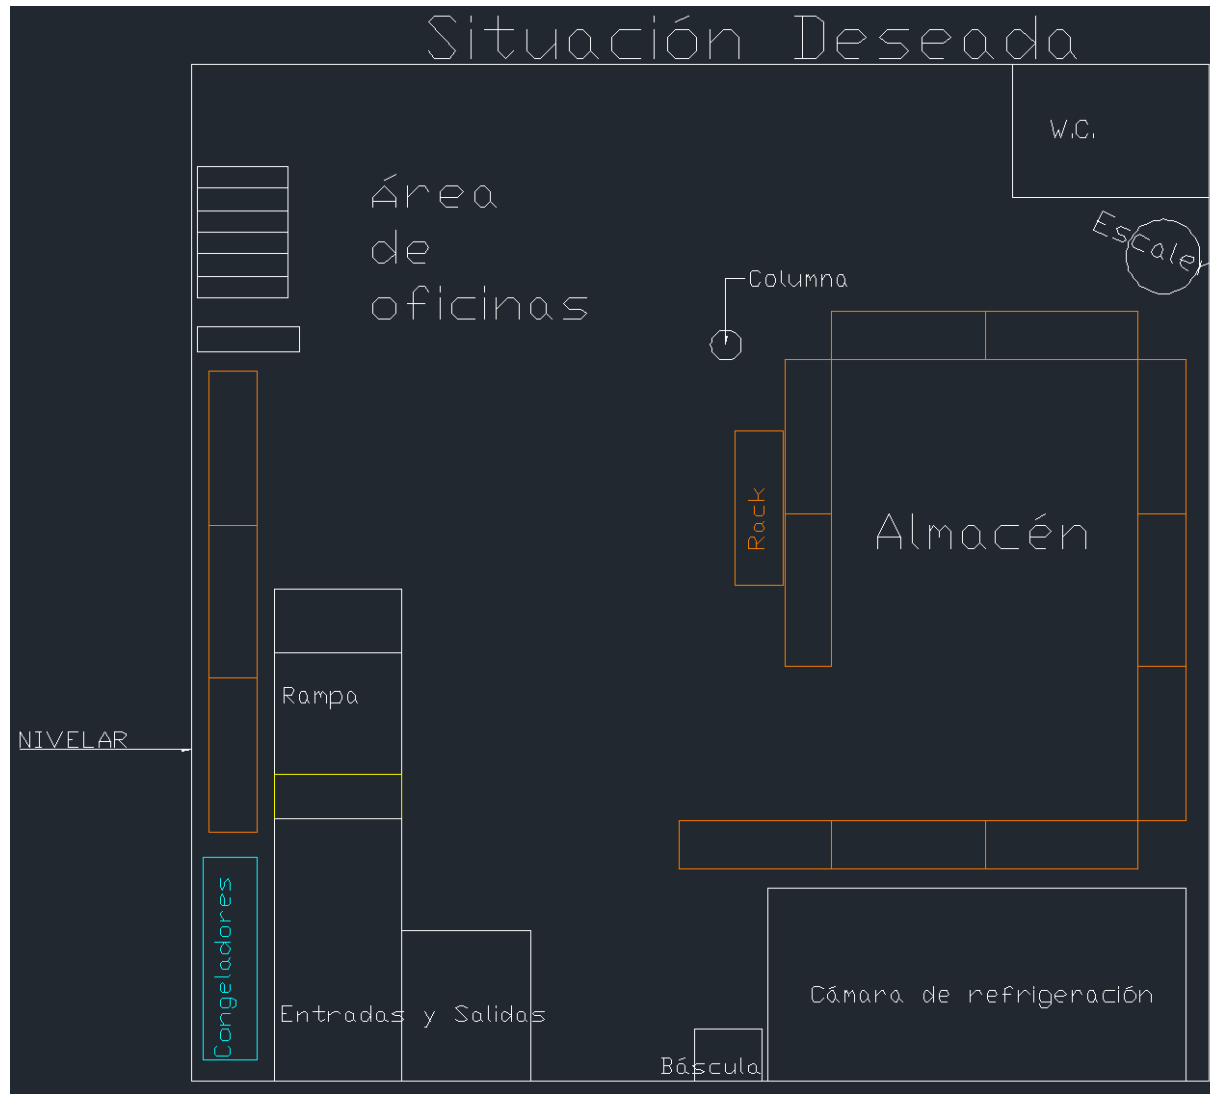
Layout de la situación deseada del almacén. Fuente: AutoCAD.
